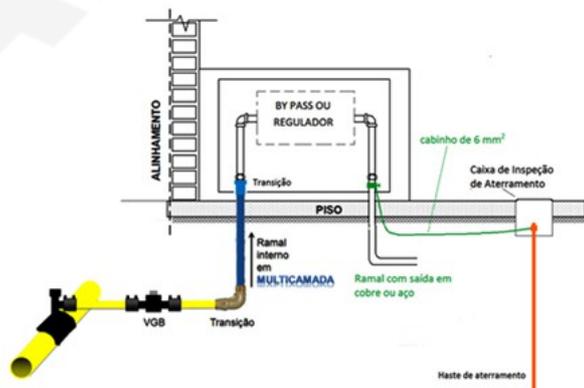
Abrigo de CR com tubo multicamadas e saída em tubo de cobre ou aço
